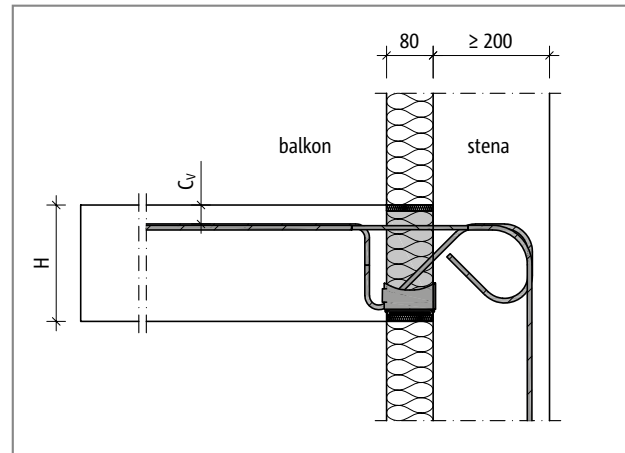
Schöck Isokorb® T tip KL-BH: višje ležeči balkon in zunanja izolacija
